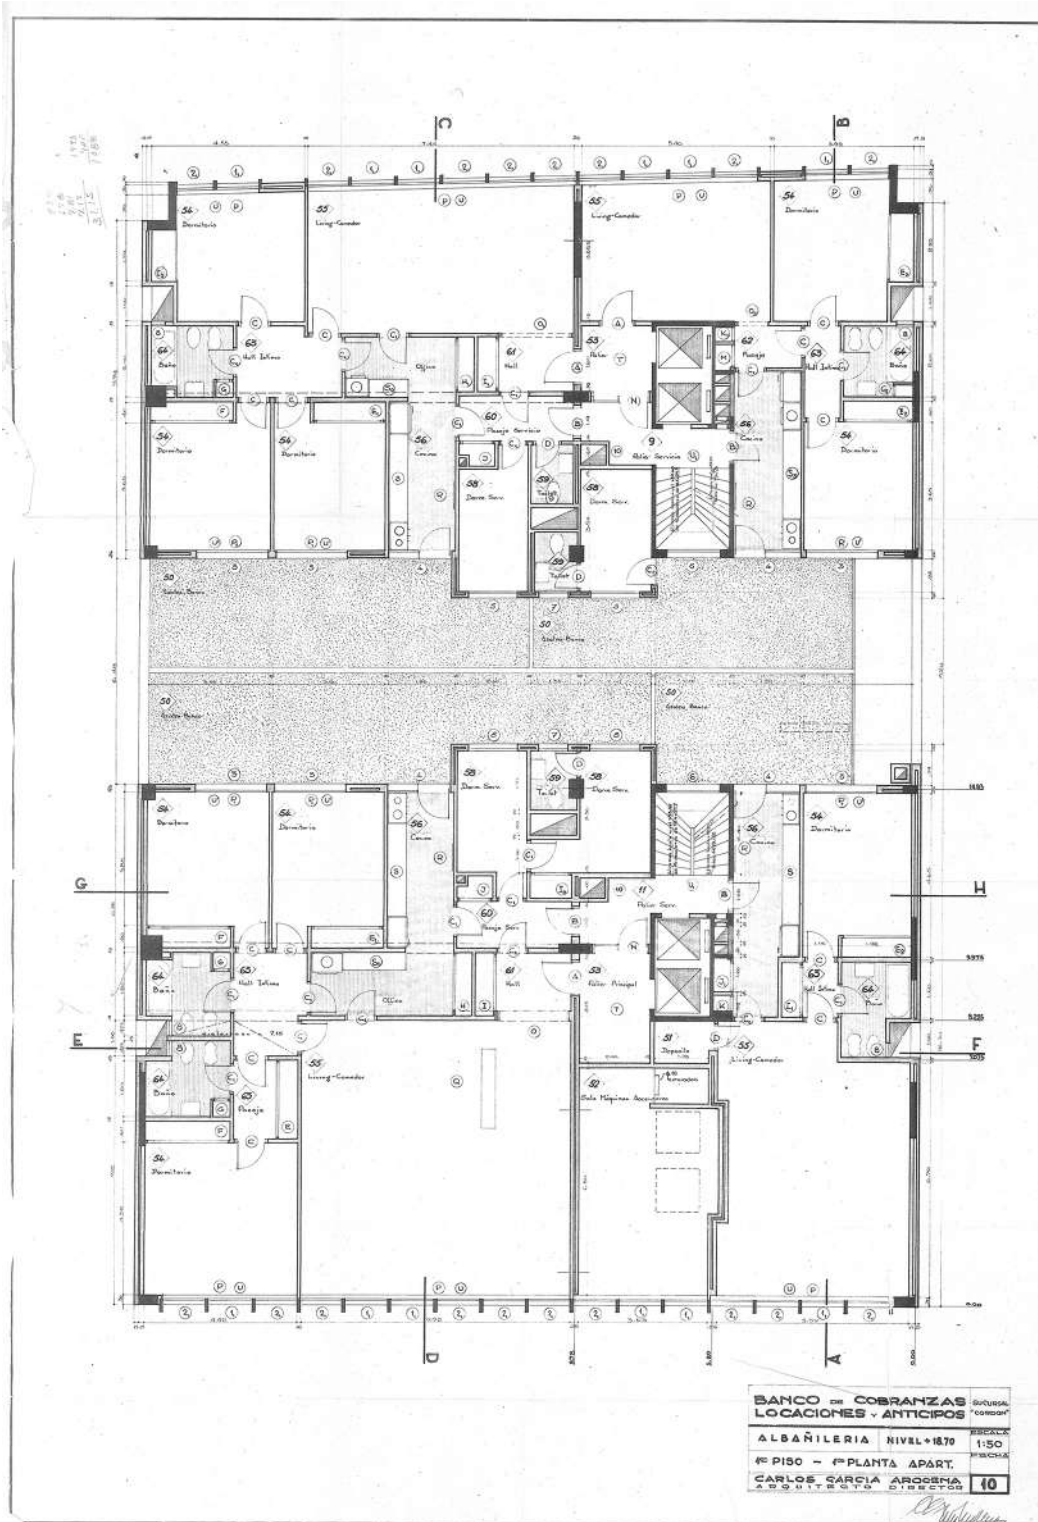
Lámina 10 del proyecto ejecutivo del BCLA: planta del piso 4.
